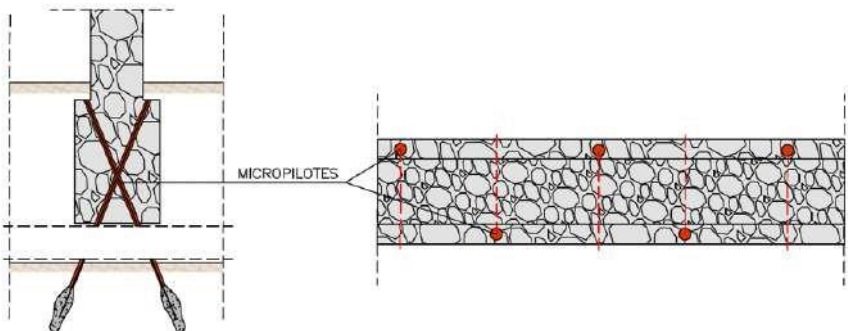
Refuerzo zapata corrida bajo muro. Tipo 3. Micropilotes. Fuente propia
